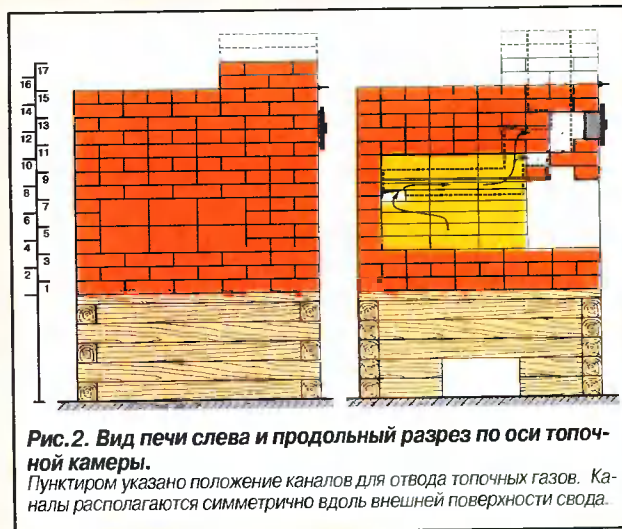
Вид печи слева и продольный разрез по оси топочной камеры.
